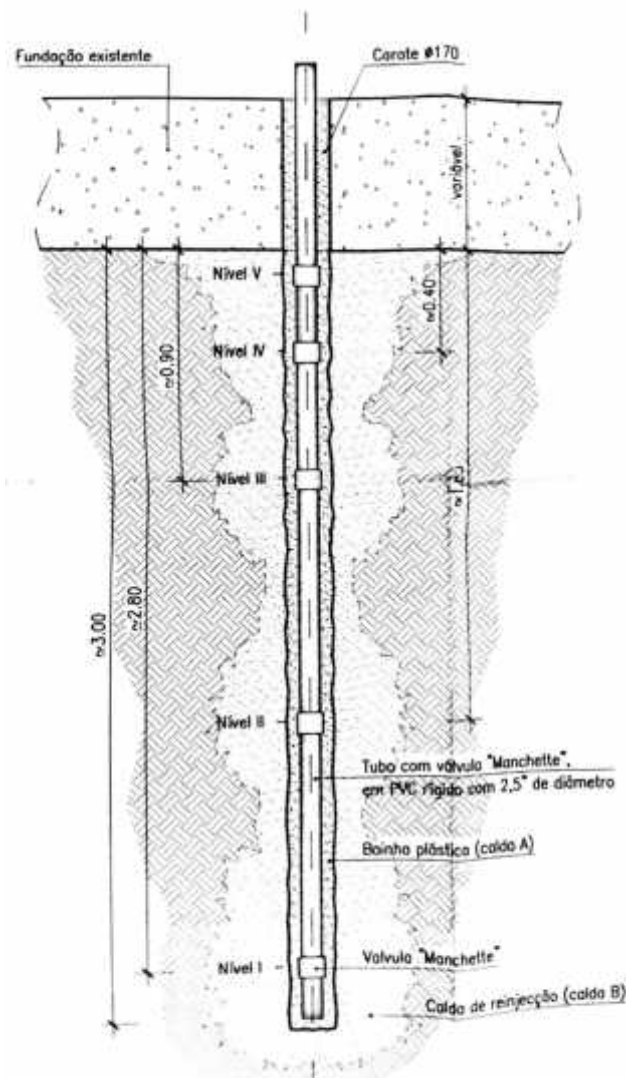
Esquema do sistema de injeção de calda de cimento no solo de fundação.
